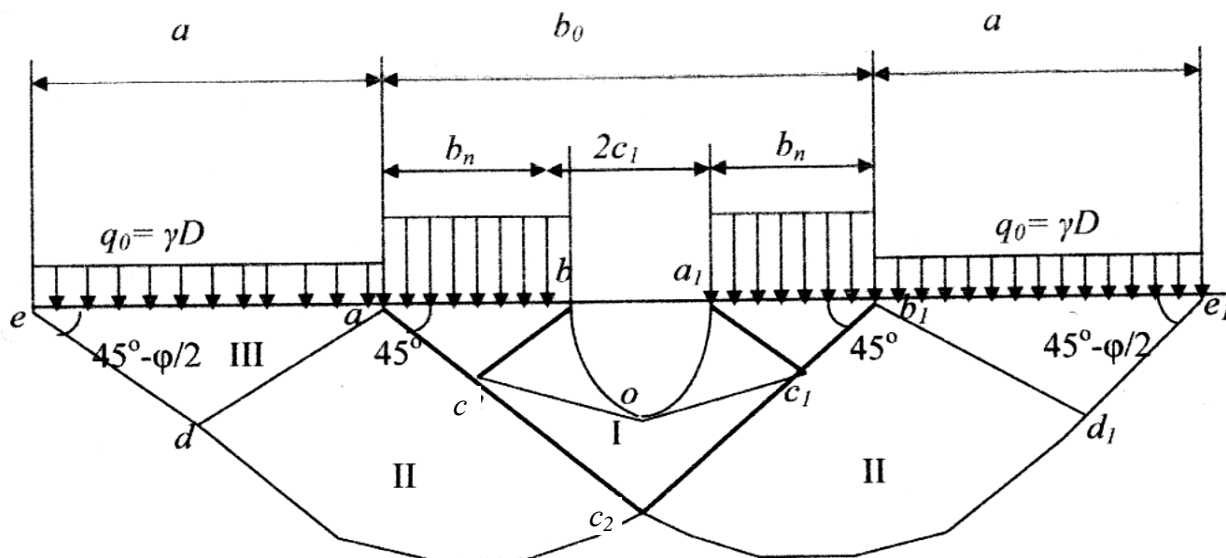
Схема распределения зон упруго-пластических деформаций под подошвой прерывистого ленточного фундамента из плит с плоской подошвой.
